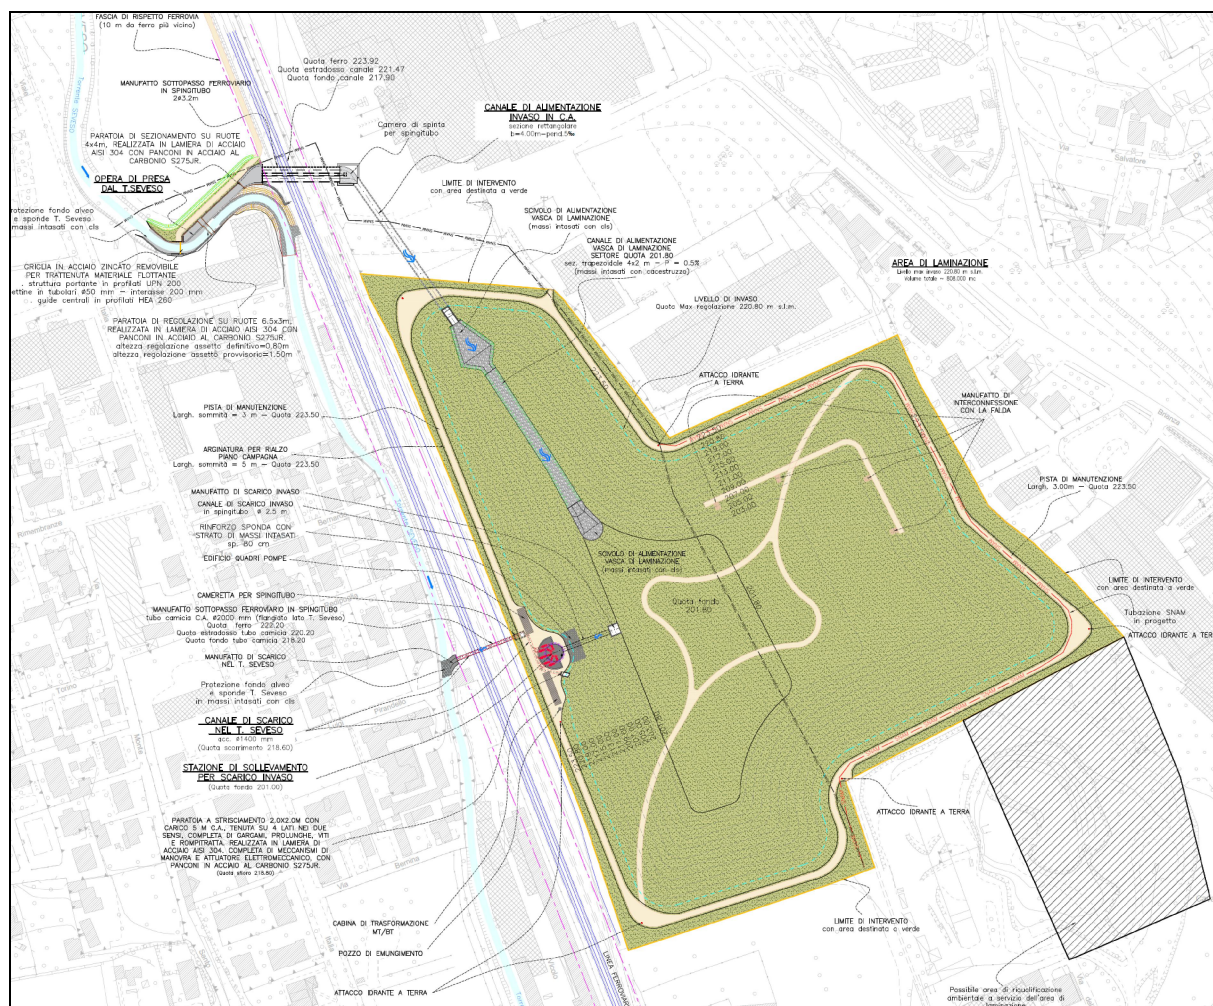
Schema planimetrico dell'area di laminazione in scavo di Lentate sul Seveso
